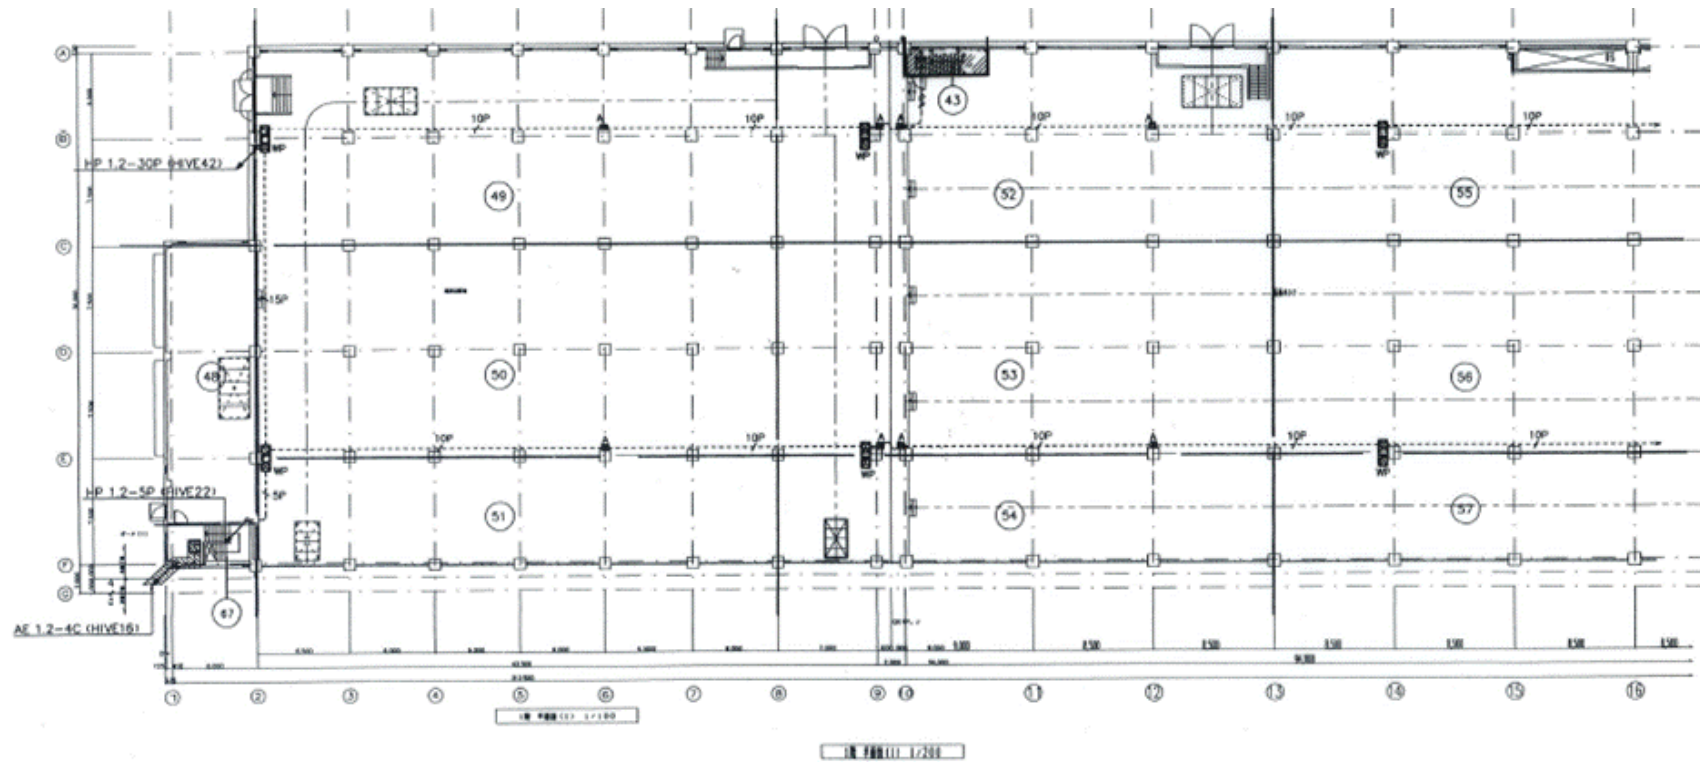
系水処理棟（最初沈殿池） 地下1階平面図（既設）
